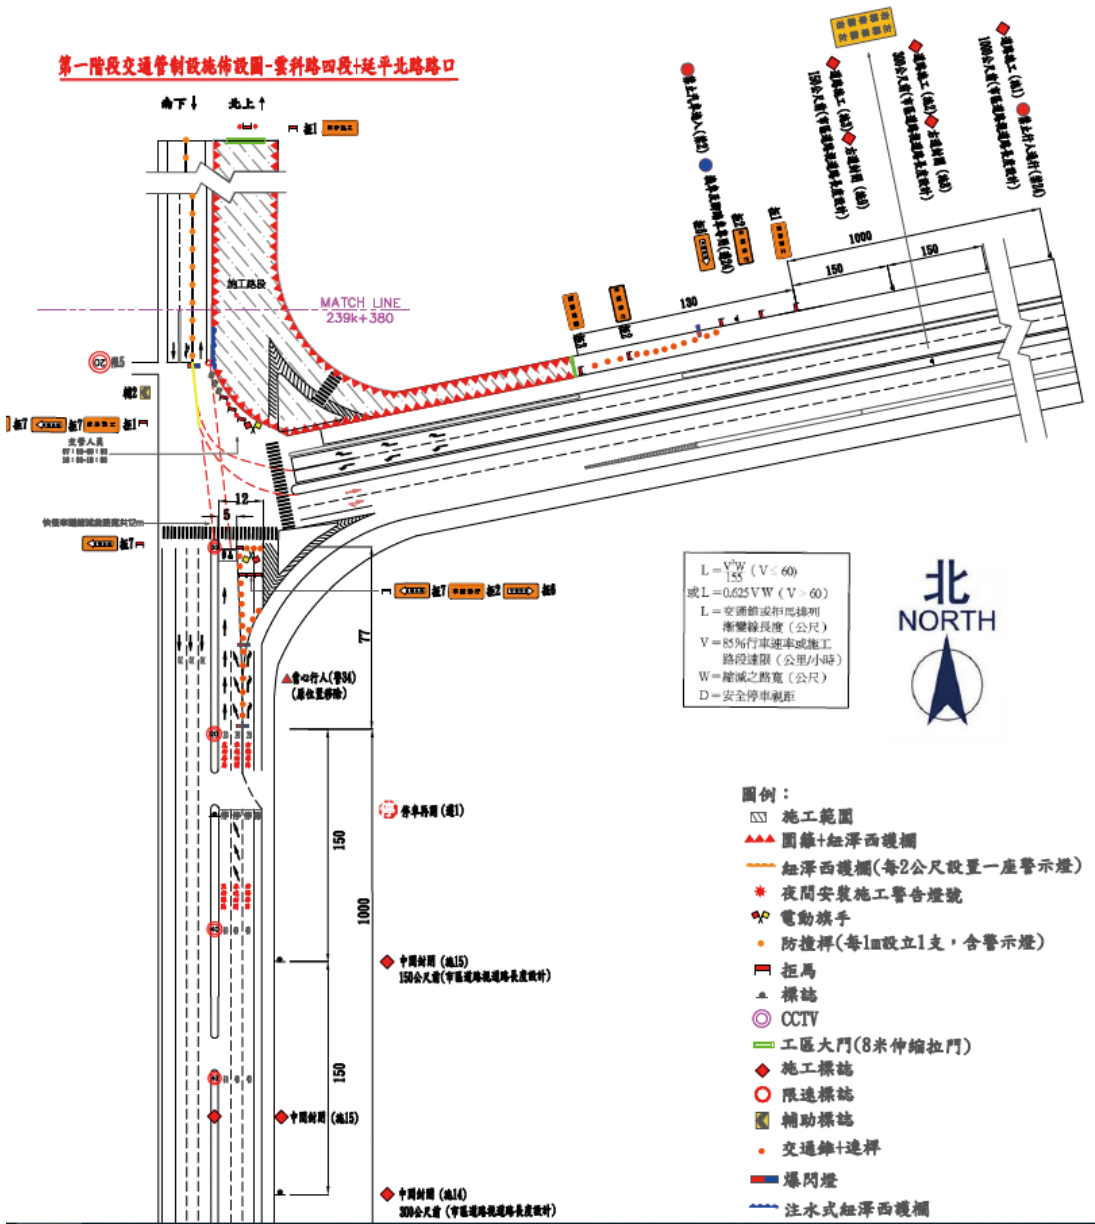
第一階段施工交維車行路徑平面圖示 (南端)
